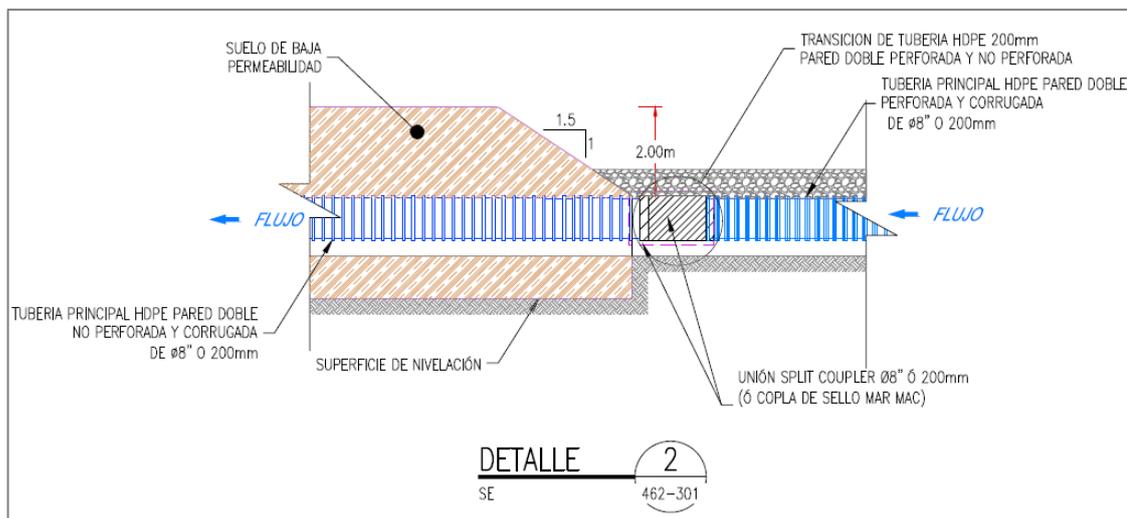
Detalle de transición de tubería en sistema de drenaje.
